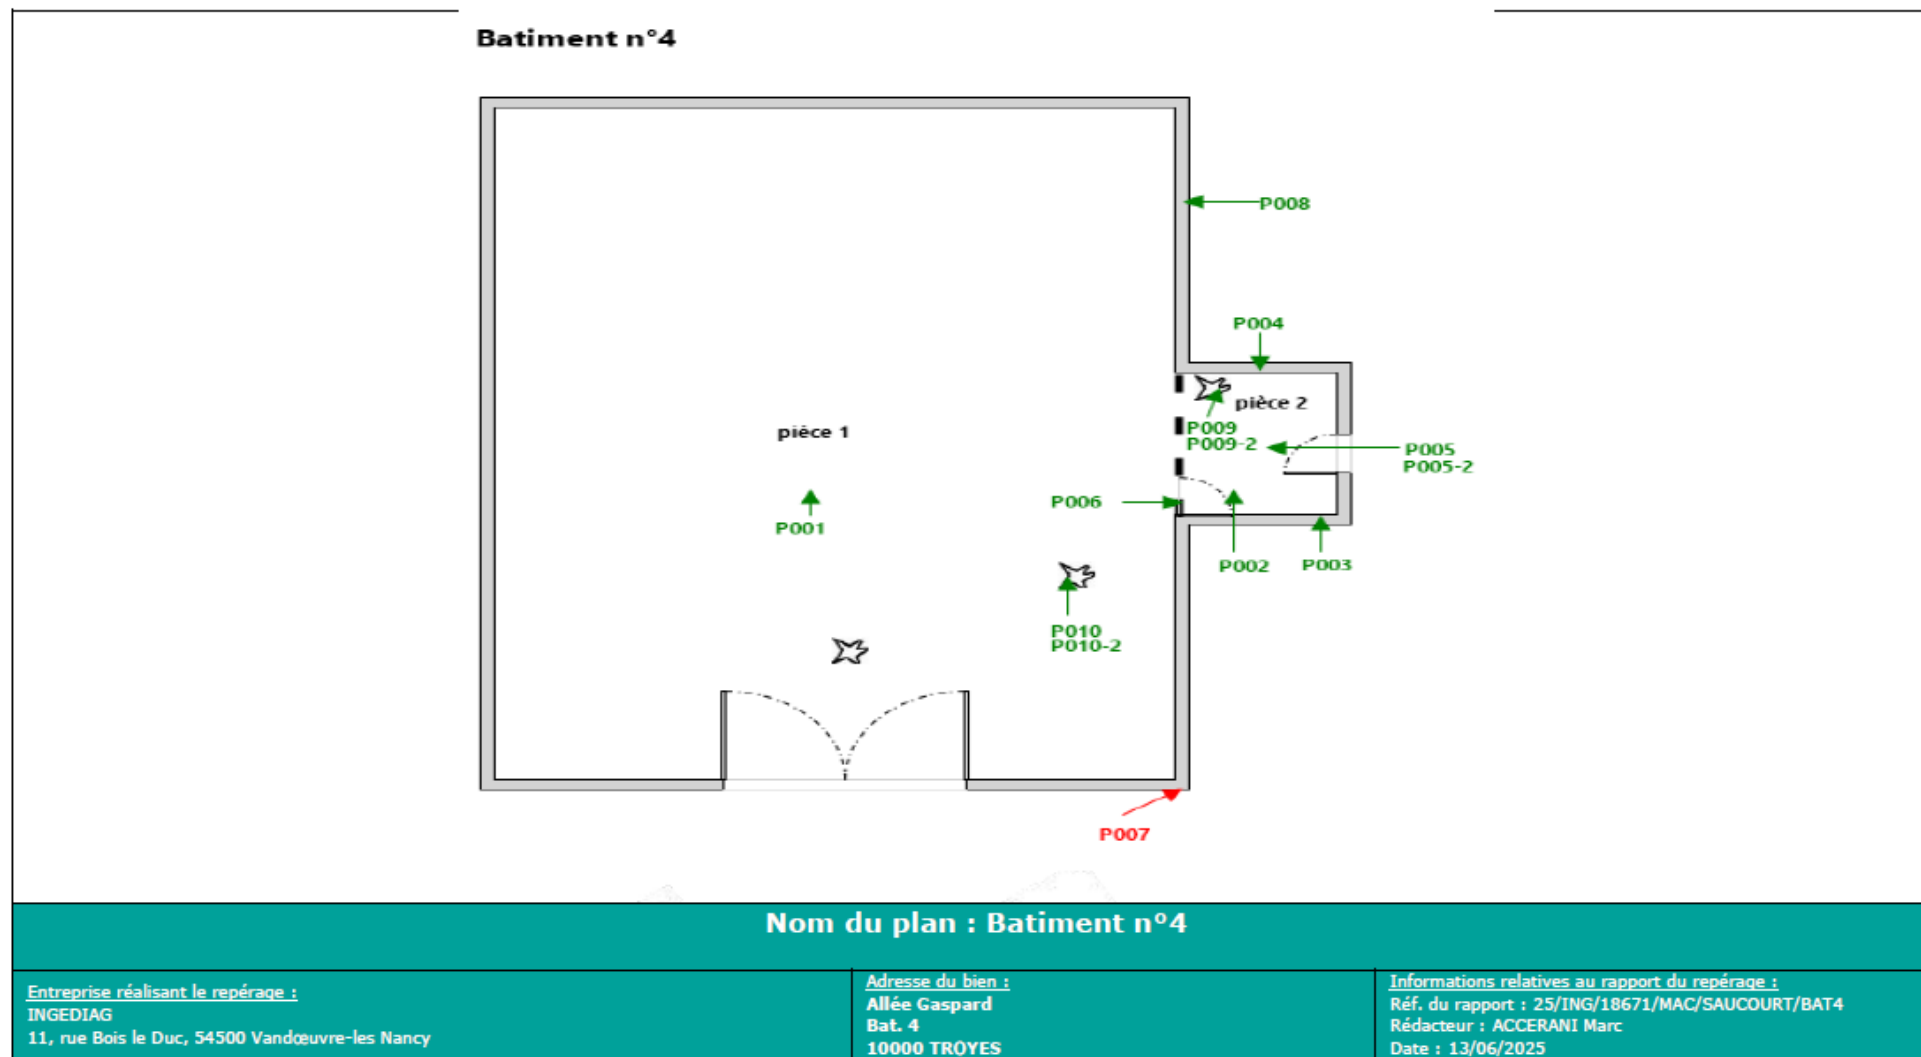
Plan de localisation des prélèvements amiante dans le bâtiment 4
